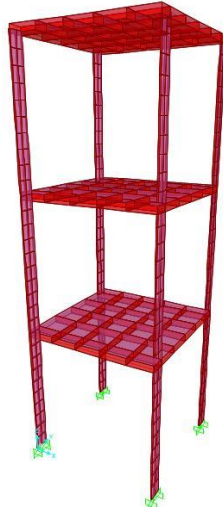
Modelo de casca utilizado no cálculo da estrutura em SAP2000.
